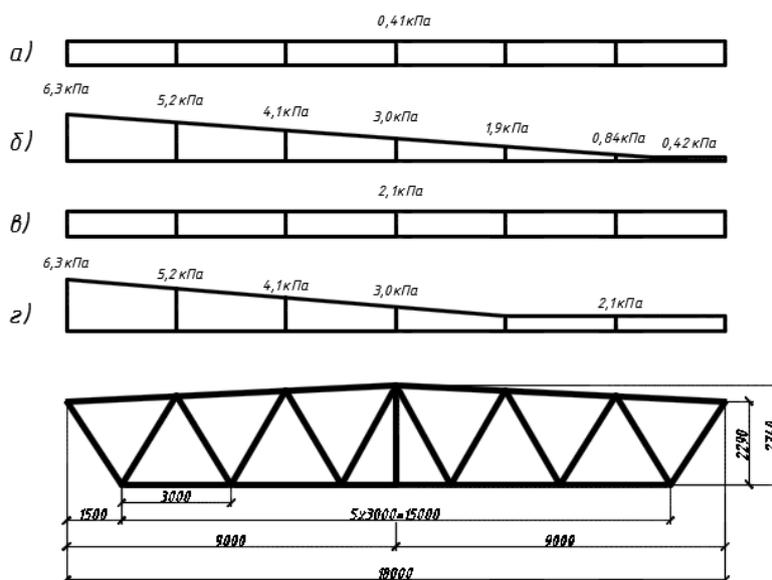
Схемы распределения постоянной и снеговых нагрузок на покрытие для расчета прогонов: а) постоянная расчетная нагрузка; б) расчетная снеговая нагрузка с коэффициентом $\mu > 1$; в) расчетная снеговая нагрузка с коэффициентом $\mu = 1$; г) расчетная схема приложения снеговой нагрузки на покрытие при расчете прогонов
